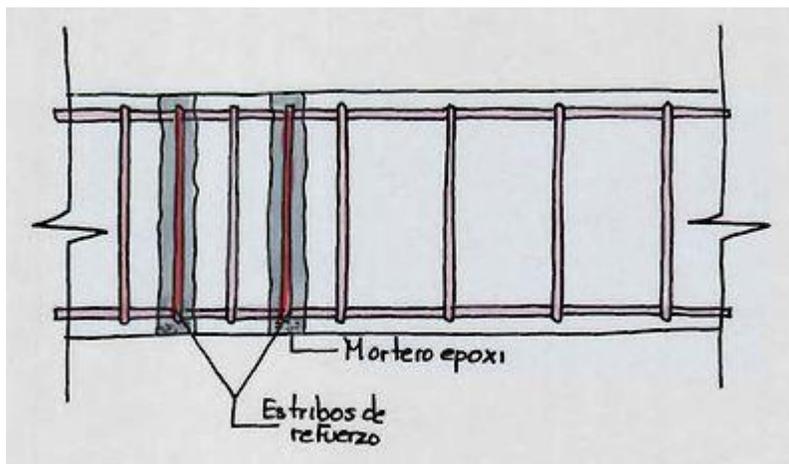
Estribos de refuerzo para una viga que falla por cortante.
